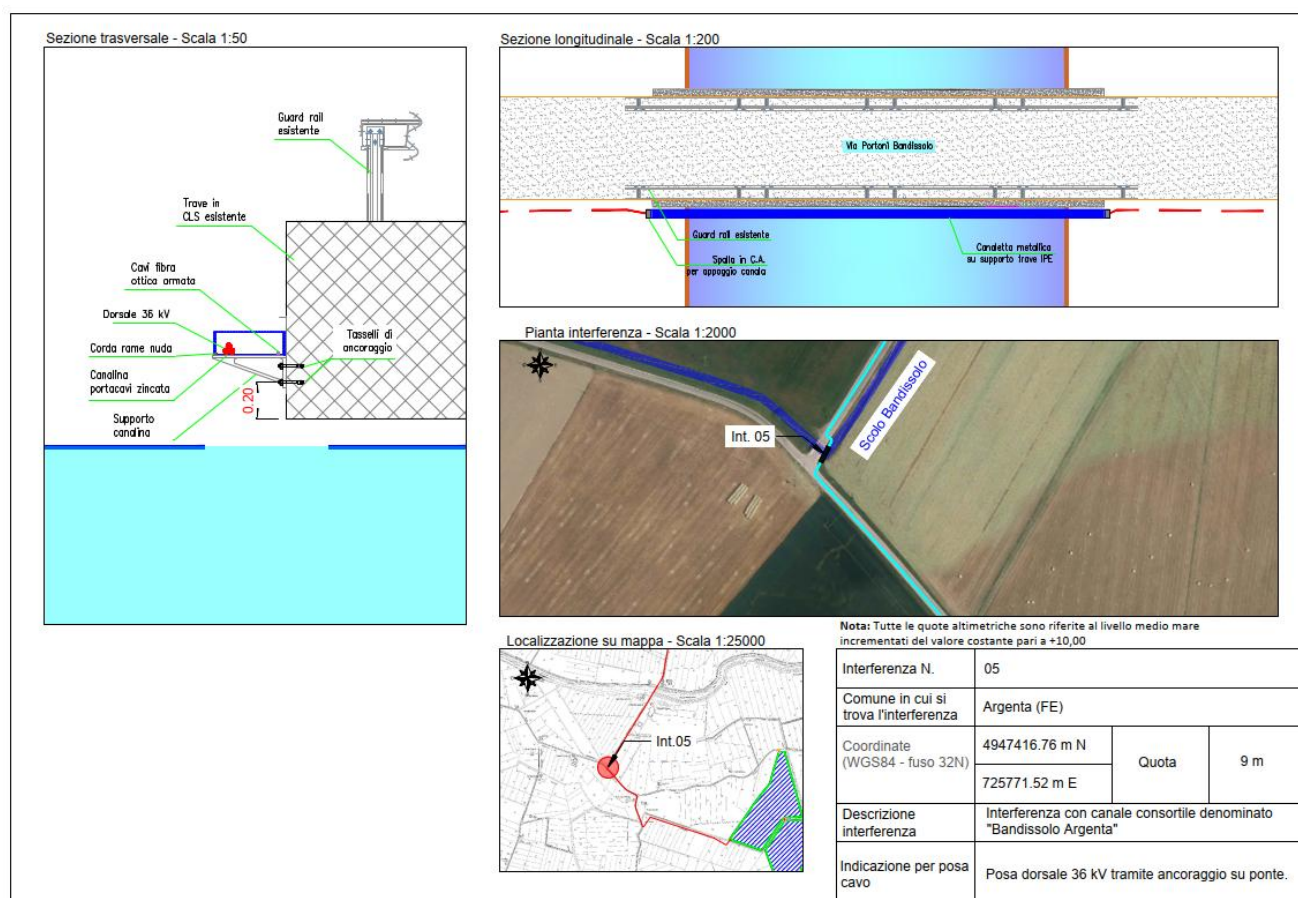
Dettaglio Posa cavo – Ancoraggio al ponte
